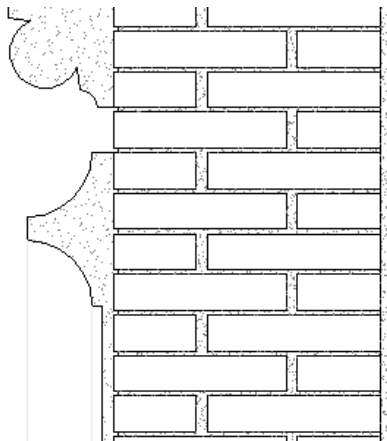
Detalle de muro de carga de fachada. Fuente propia.
